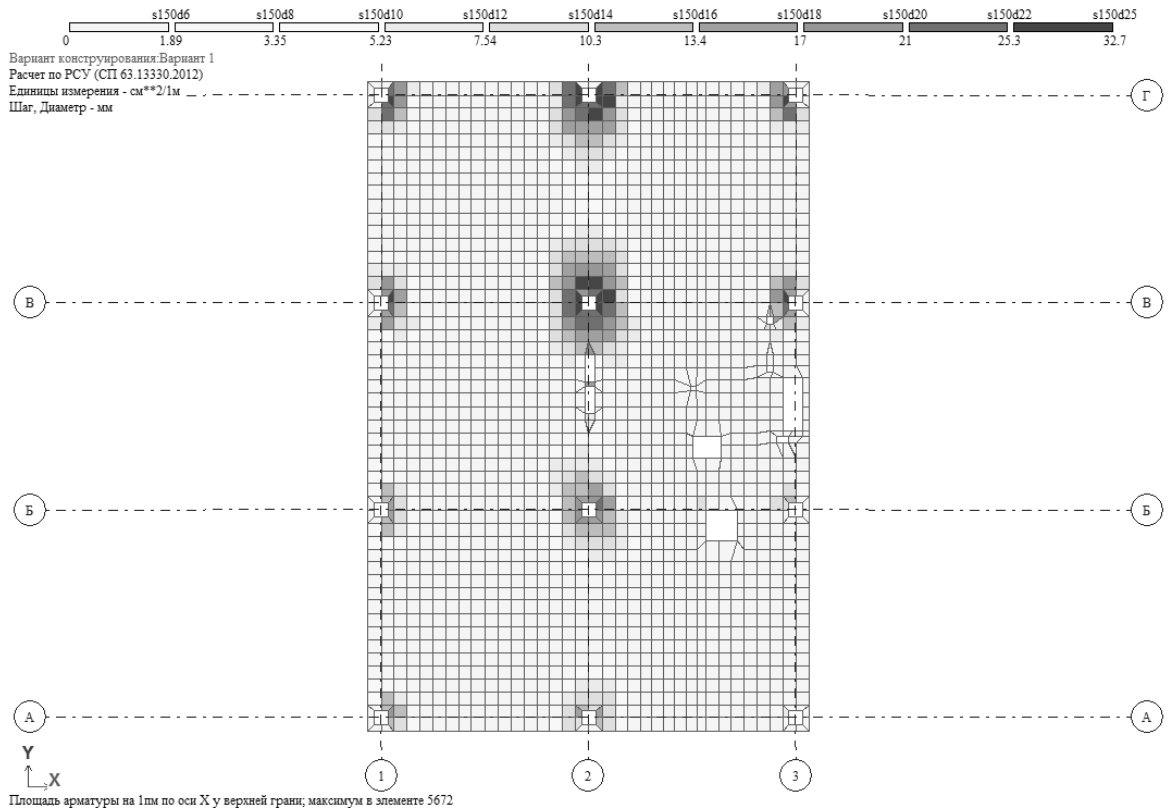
Армирование плит покрытия по оси X у верхней грани
